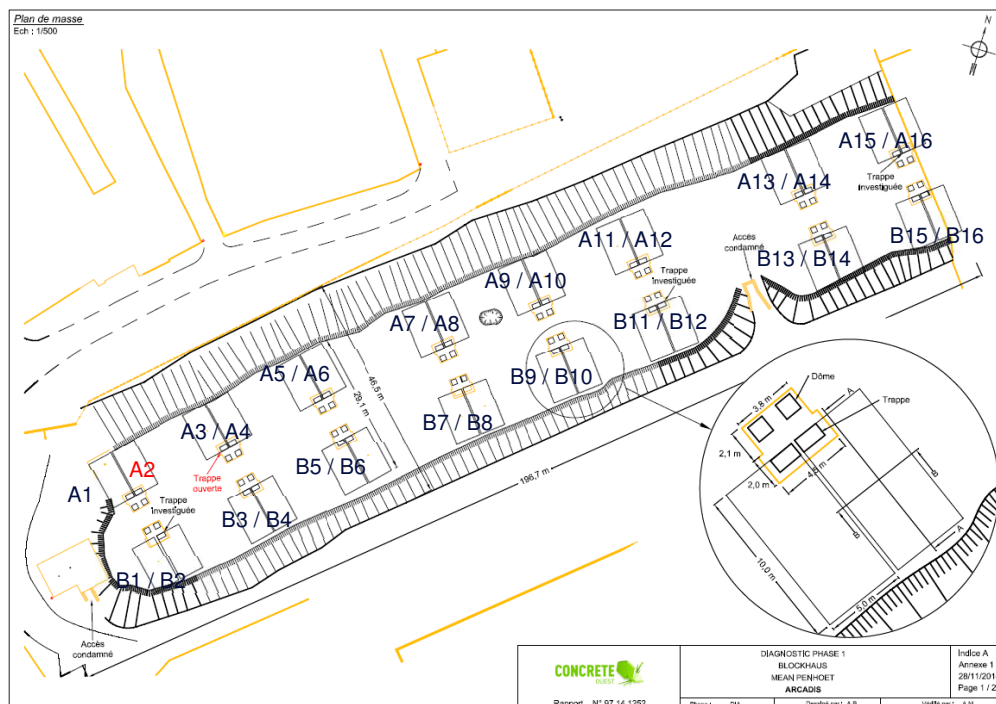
Plan masse du bunker avec les alvéoles (Source : Extrait du rapport CONCRETE n° A97 14 1252 du 28 novembre 2014)
